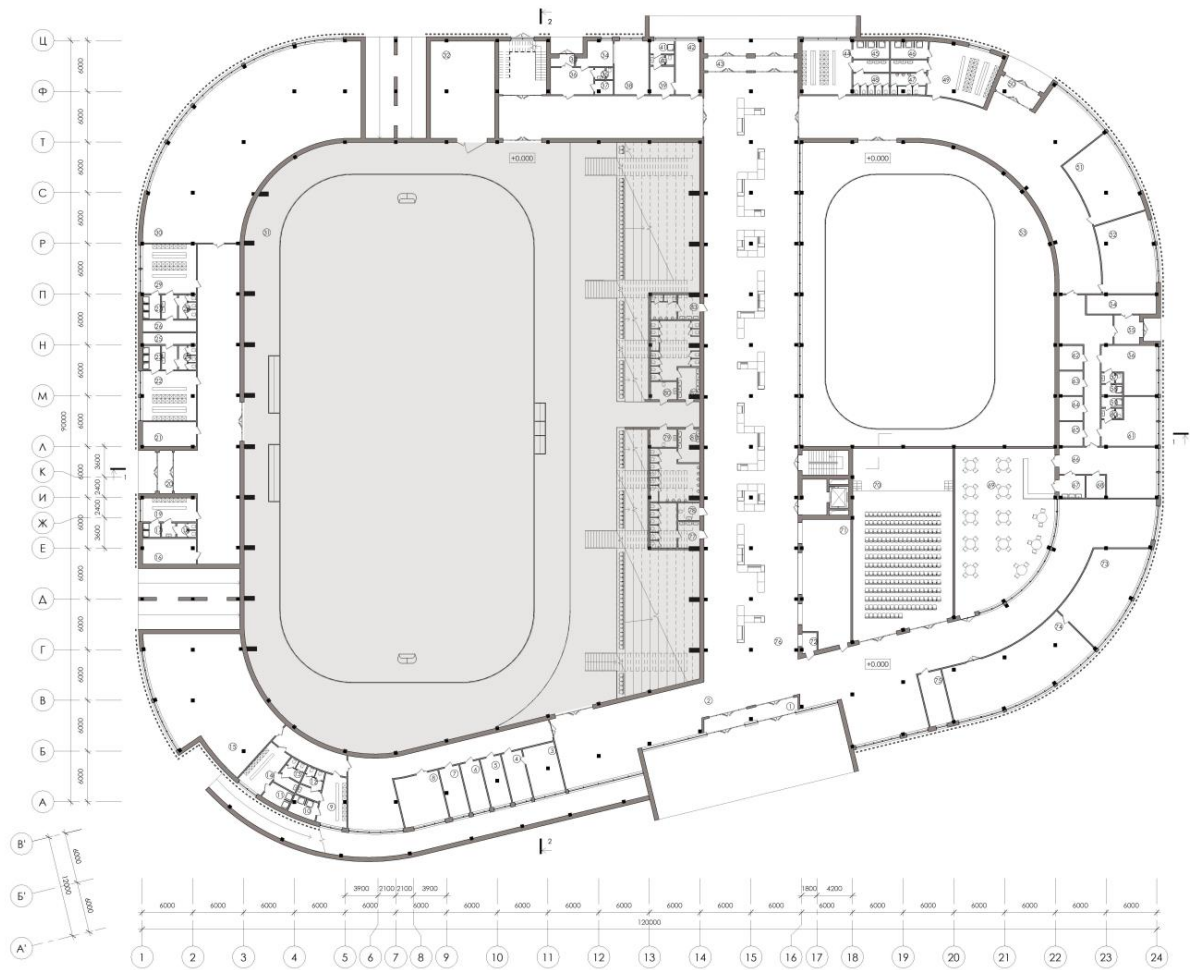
Розміщення льодової арени на плані поверху запроєктованої будівлі
